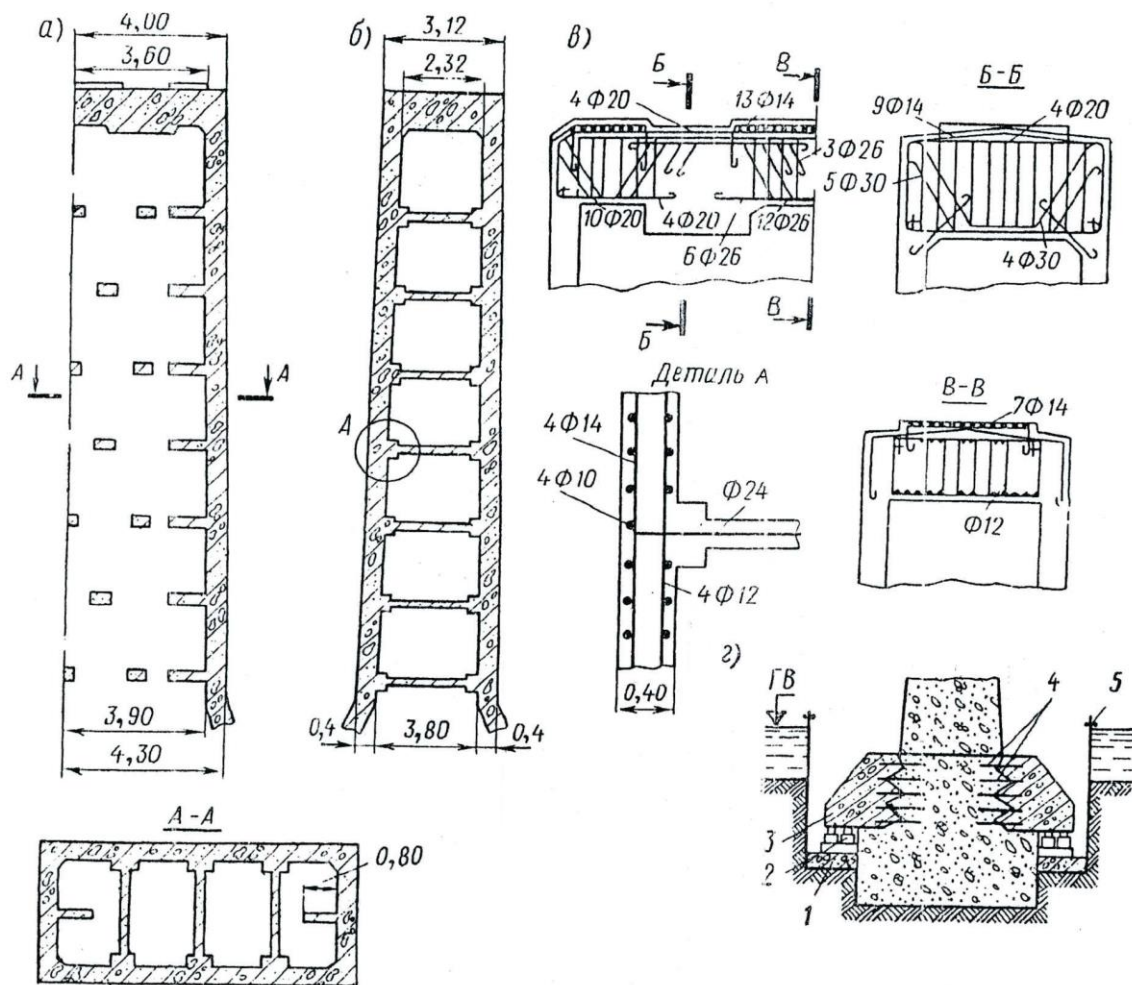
Конструкция усиления тела и фундамента опор
